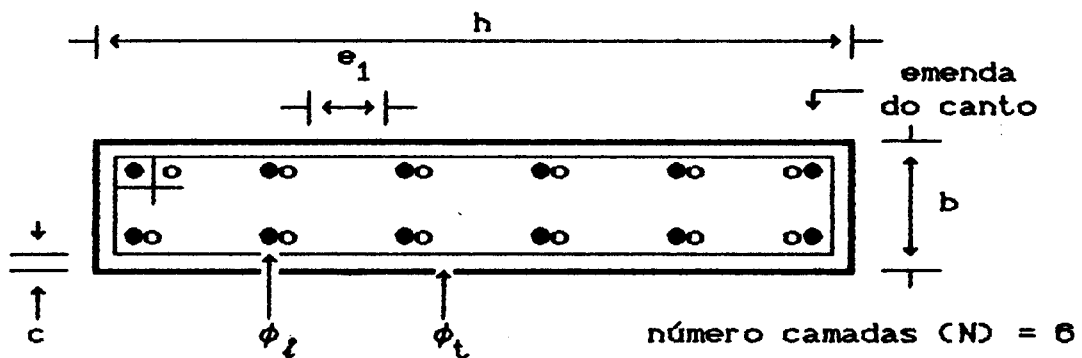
Espaçamento mínimo entre barras longitudinais.
